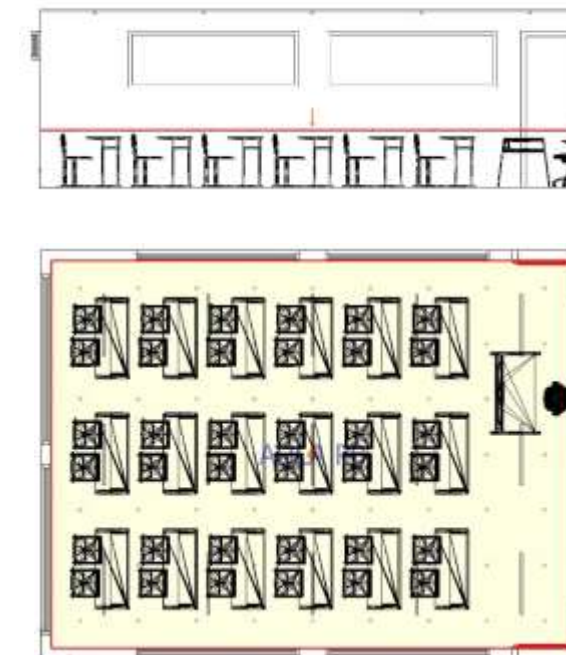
Definición de plano de trabajo para estudio de iluminación planta baja. Fuente DIALux Evo. (DIAL GmbH, 2024)
